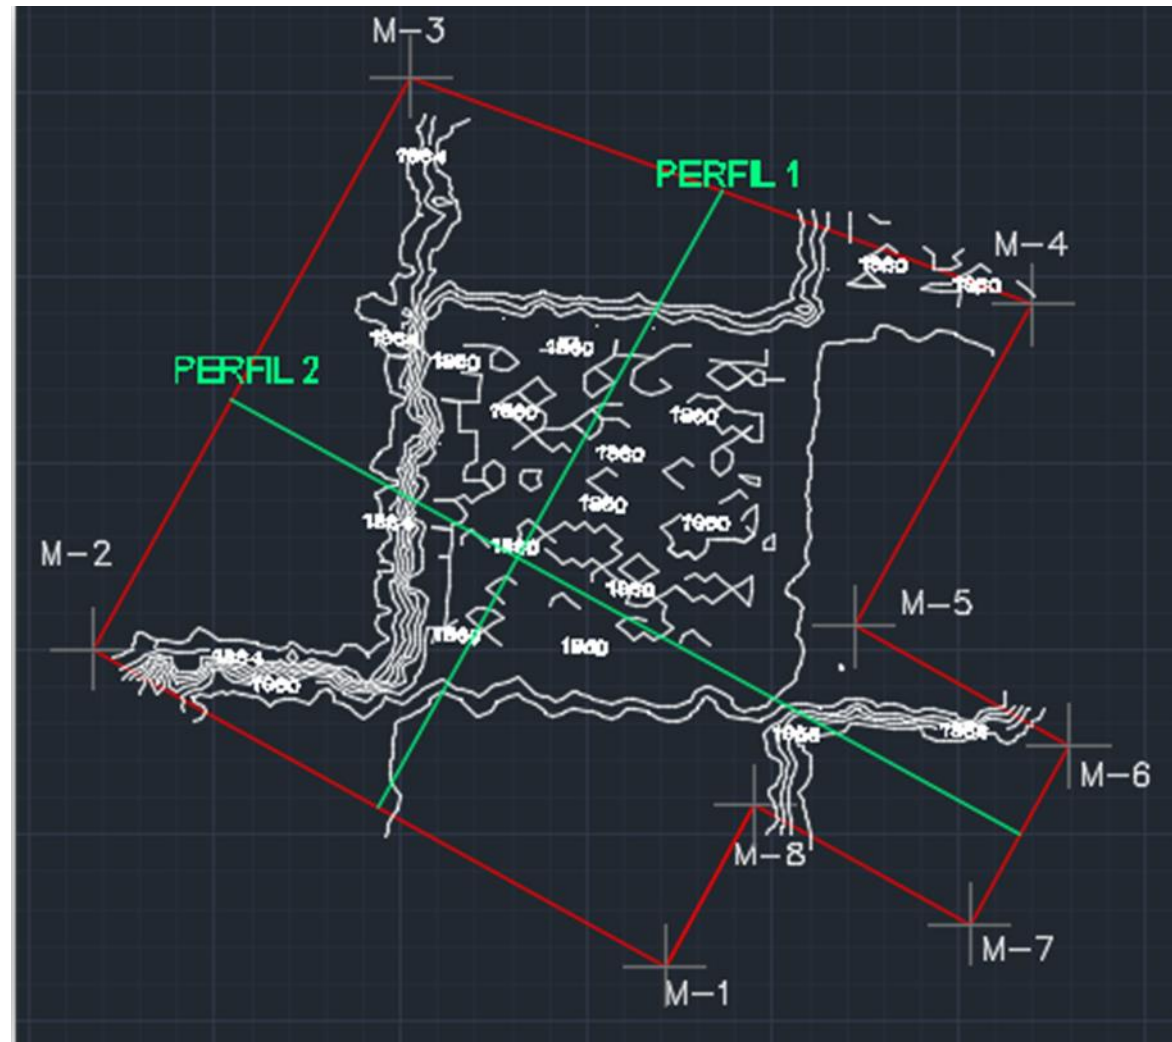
ESTUDIO DEL TERRENO PERFILES
